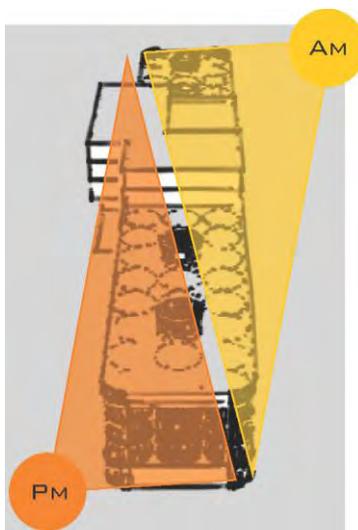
Asolación sobre el edificio la disposición del volumen se encuentra con las fachadas mas cortas norte- sur y las mas largas este-oeste generando una mayor captación de luz en horas de la mañana en la fachada este y en horas de la tarde en la fachada oeste.
